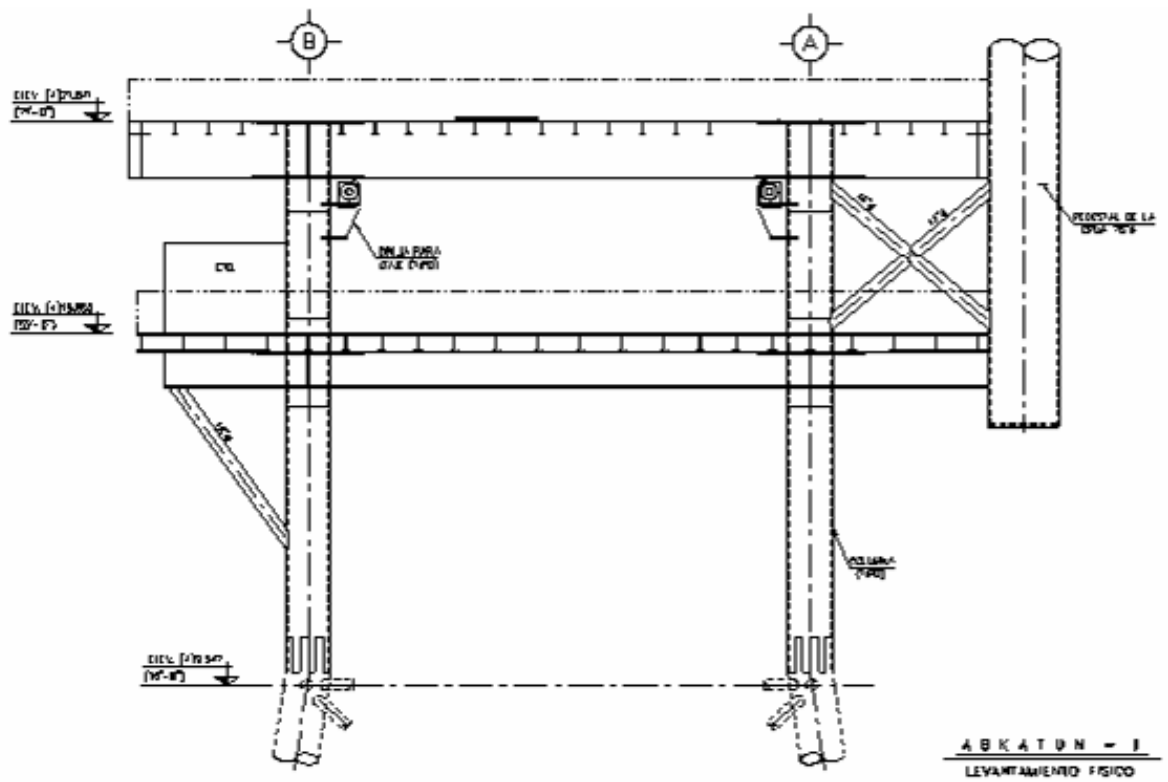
CROQUIS DE ELEVACIÓN EN EJE 2
